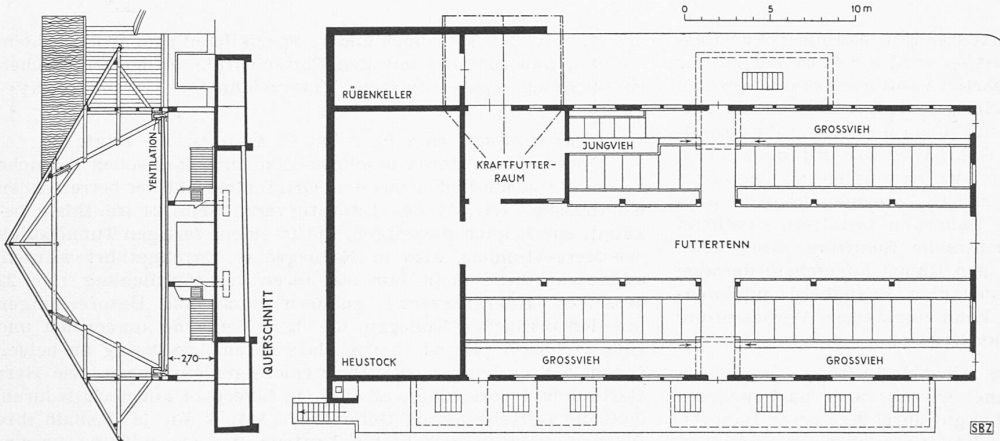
und 19. Scheune Thorberg, Grundriss und Schnitt 1 : 400. — Arch. A. WYTENBACH
